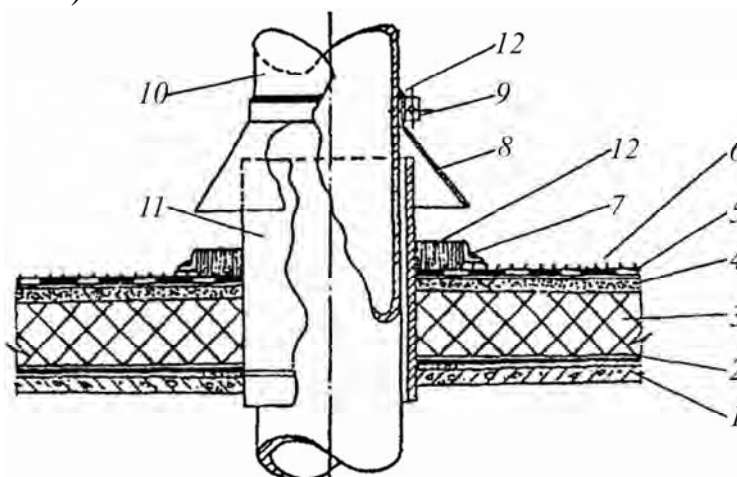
Примыкание кровли к трубе: *1* — железобетонная плита покрытия; *2* — пароизоляция; *3* — теплоизоляция; *4* — выравнивающая стяжка; *5* — основной кровельный ковер; *6* — крупнозернистая посыпка; *7* — рамка из уголка; *8* — зонт; *9* — хомут; *10* — труба; *11* — патрубок с фланцем; *12* — герметизирующая мастика
